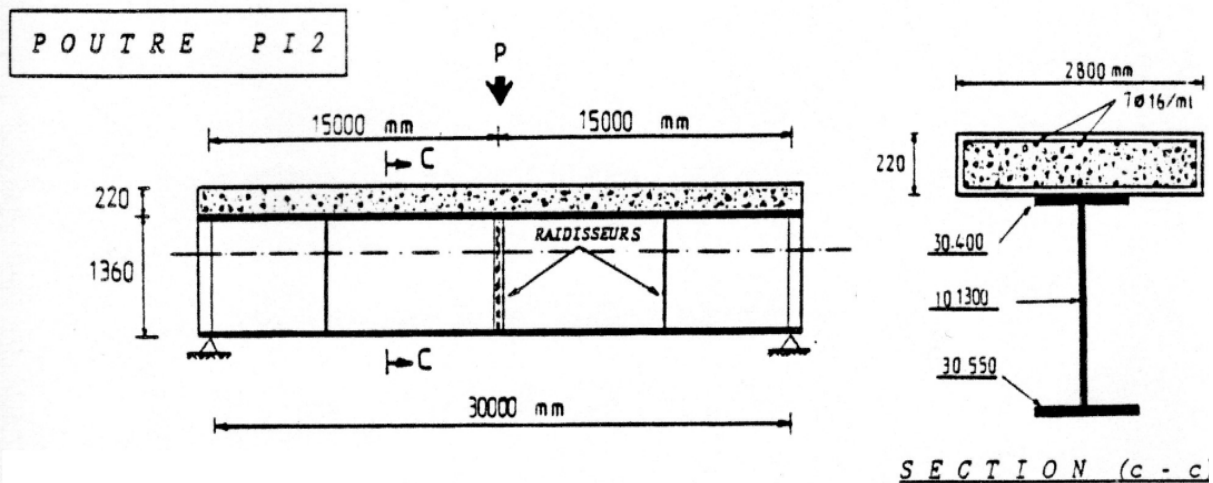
Poutre isostatique à sections mixtes PI2
